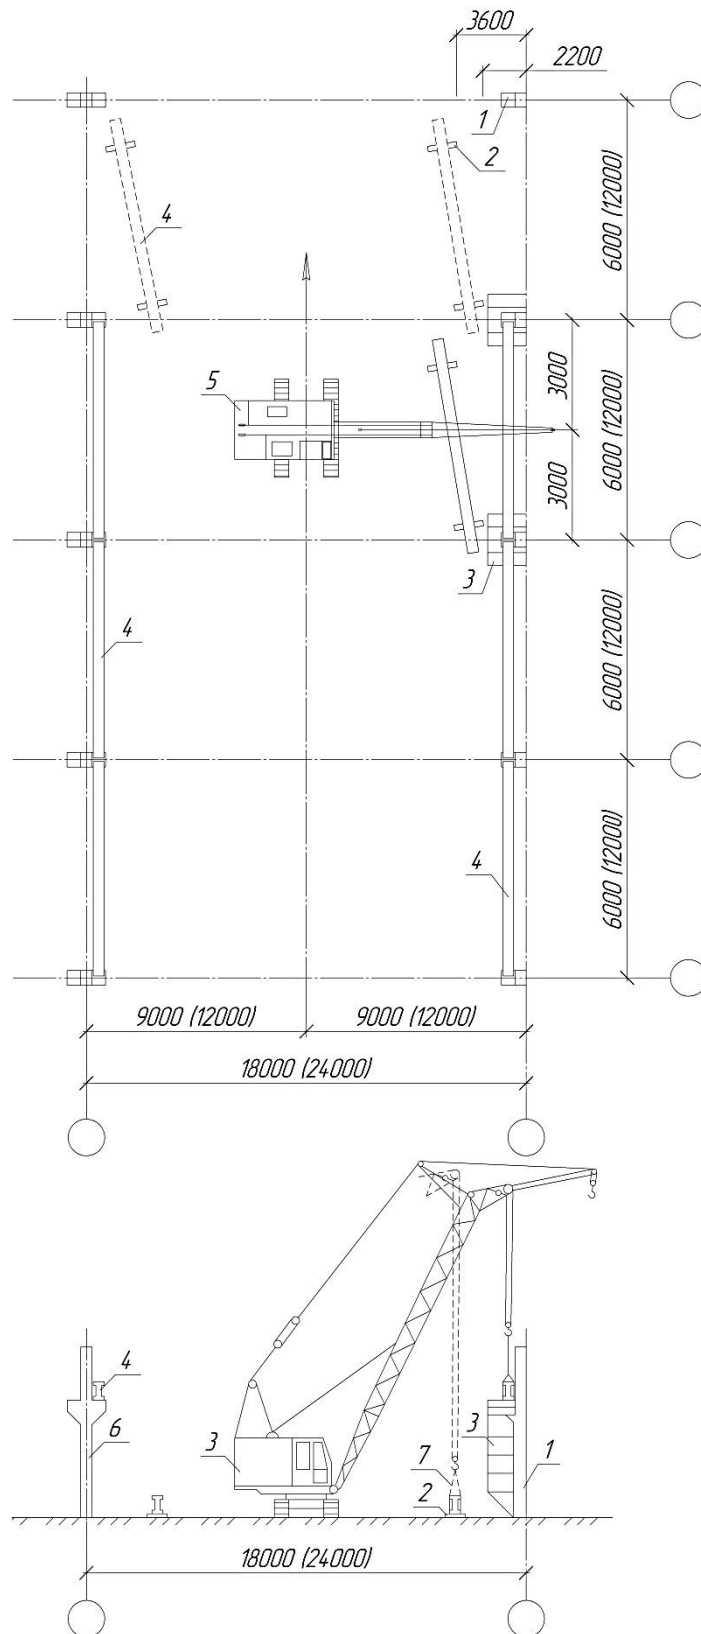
Схема монтажа подкрановых балок пролетом 6 и 12 м: 1 – колонна крайнего ряда; 2 – деревянная подкладка; 3 – приставная лестница; 4 – подкрановая балка; 5 – монтажный кран; 6 – колонна среднего ряда; 7 – строп
